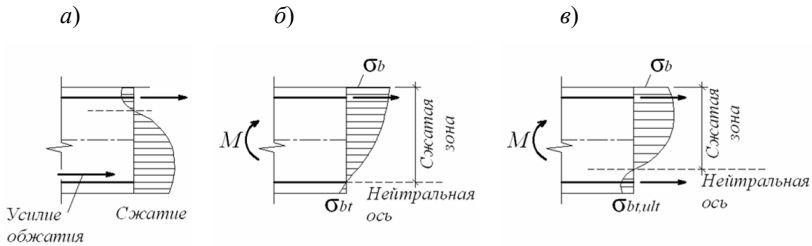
Стадии напряженного состояния изгибаемого элемента с напрягаемой арматурой: а – до загрузки внешней нагрузкой; б – усилие предварительного обжатия крайних растянутых волокон погашено внешней нагрузкой; в – конец стадии I
